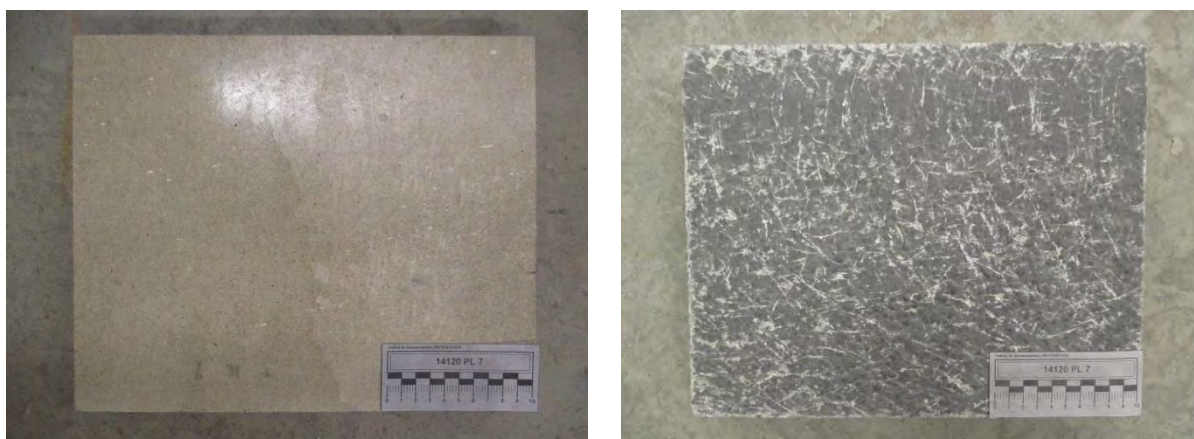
Hårdbetong – Intercrete före och efter provning
